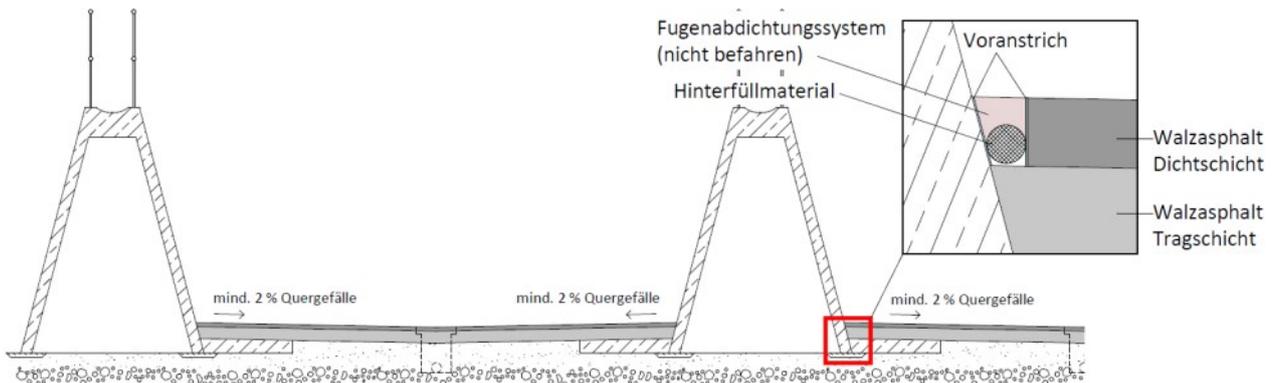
Asphalt - Betonfertigteil (schräge Wand)
